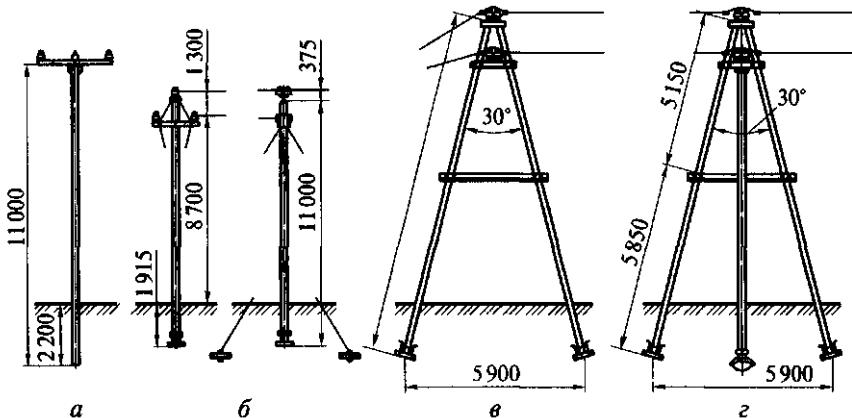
Железобетонные опоры воздушных линий напряжением 6 и 10 кВ:
